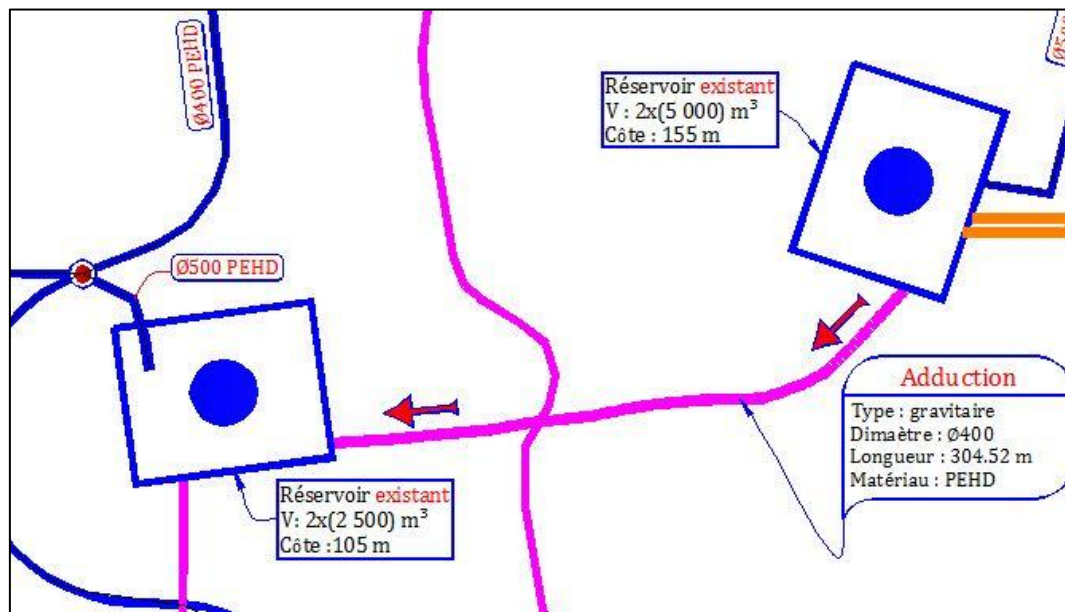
Adduction gravitaire d'un réservoir a un autre
